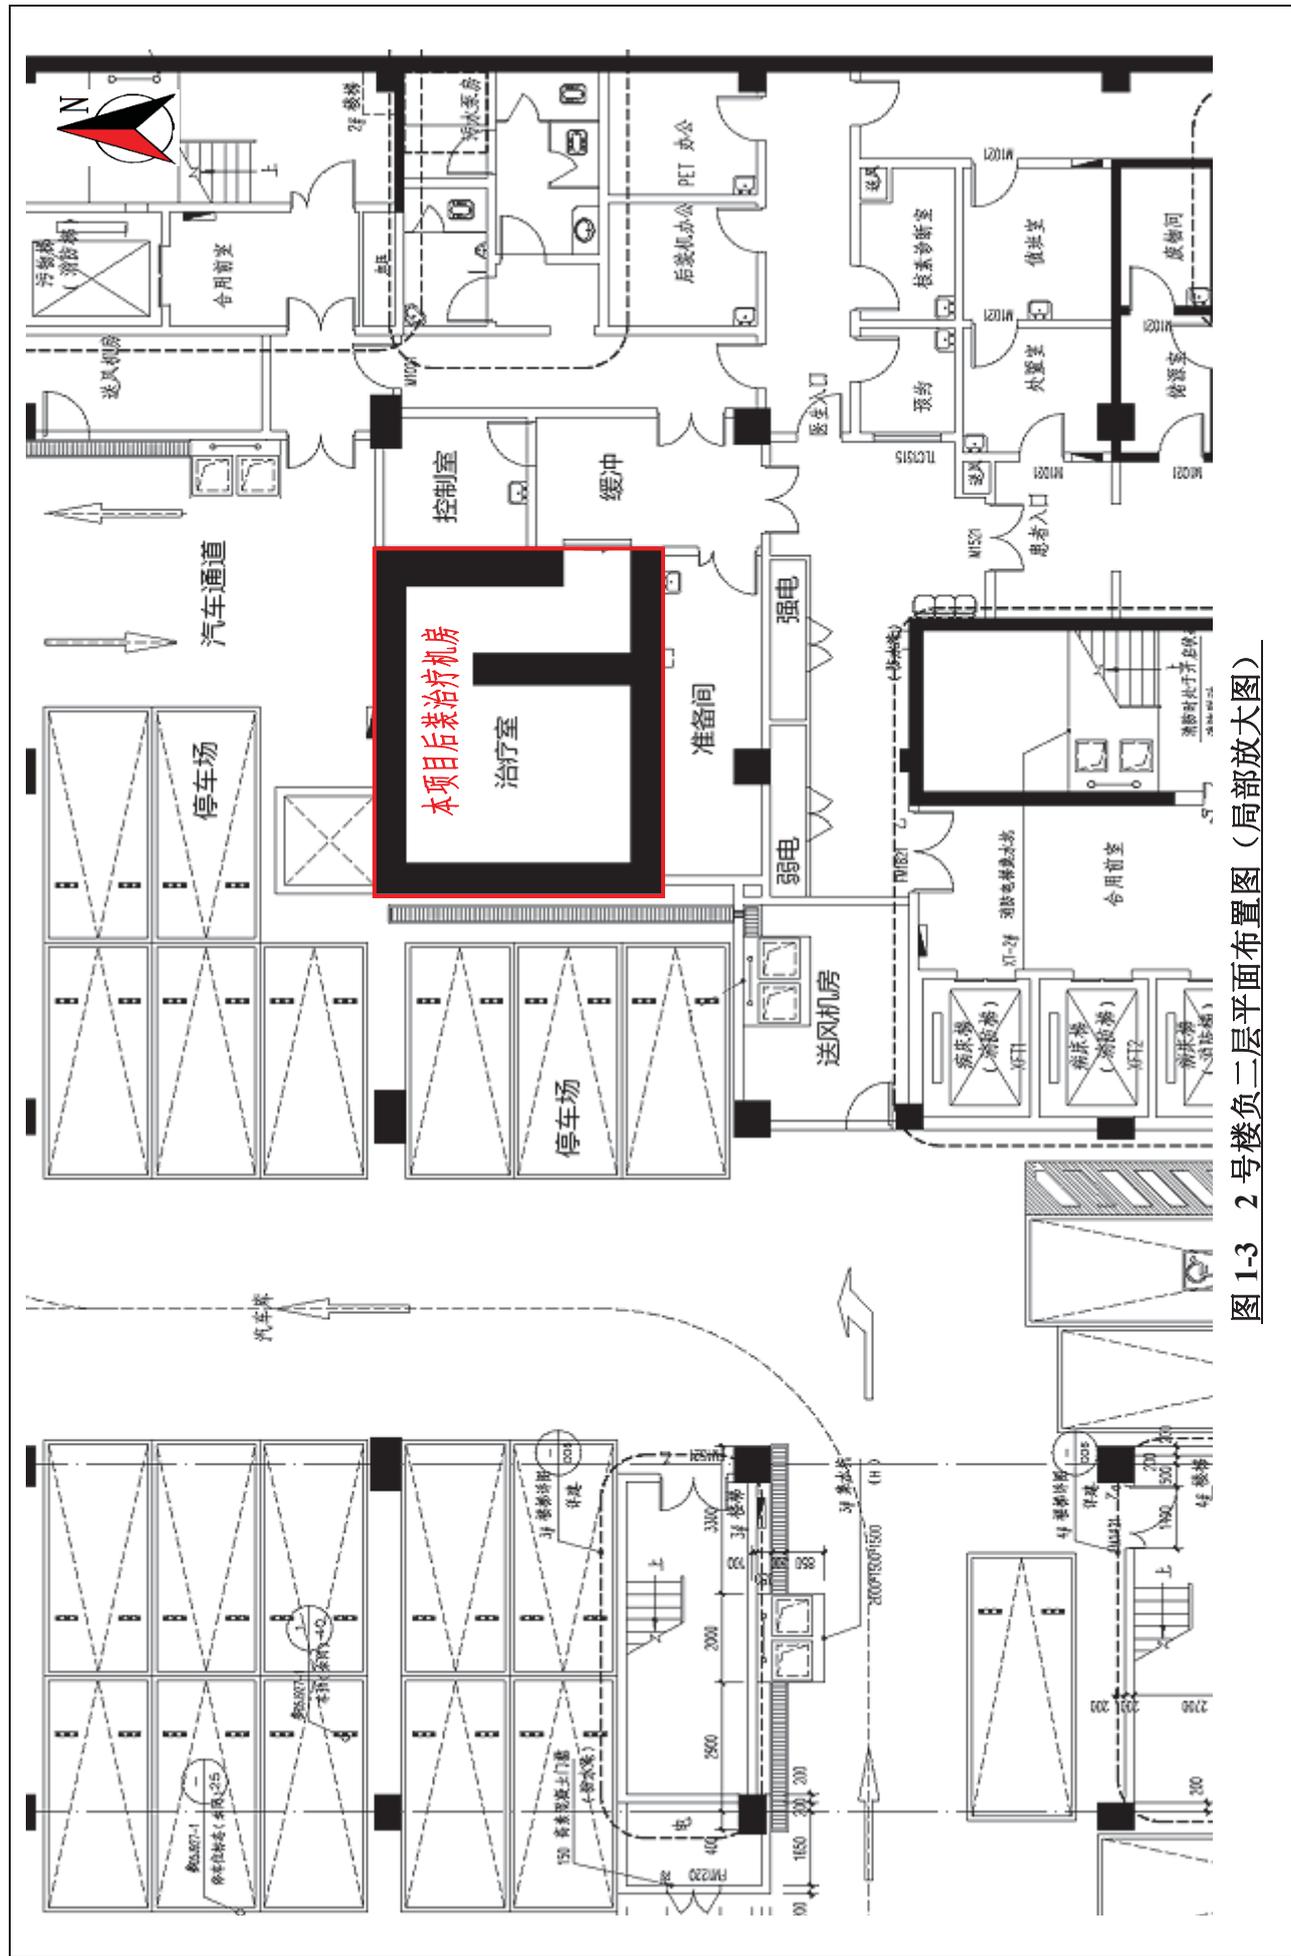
2 号楼负二层平面布置图 (局部放大图)
